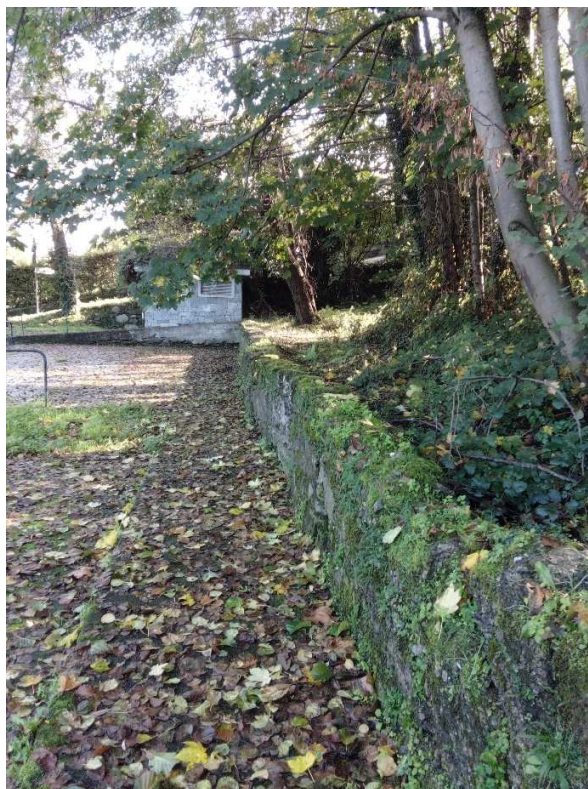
FOTO IV – DETTAGLIO SUL MURO DI CONFINE TRA IL MAPPALE 122 (PROPRIETA' FRANZIN) E IL 456 (PARCO)
